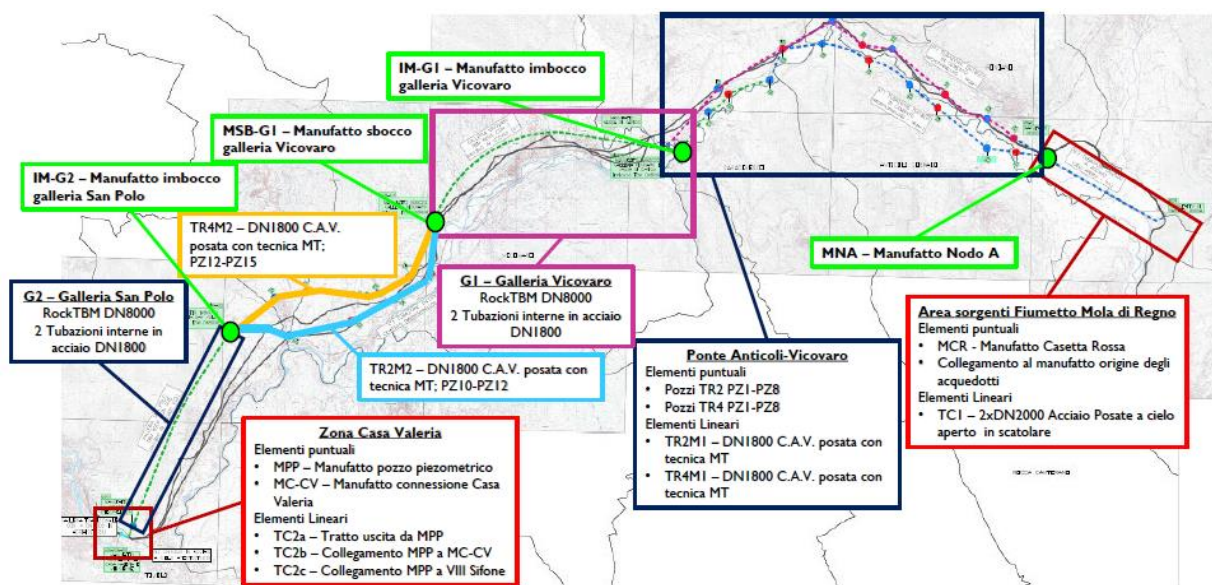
Planimetria del tracciato del Nuovo Acquedotto Marcio
